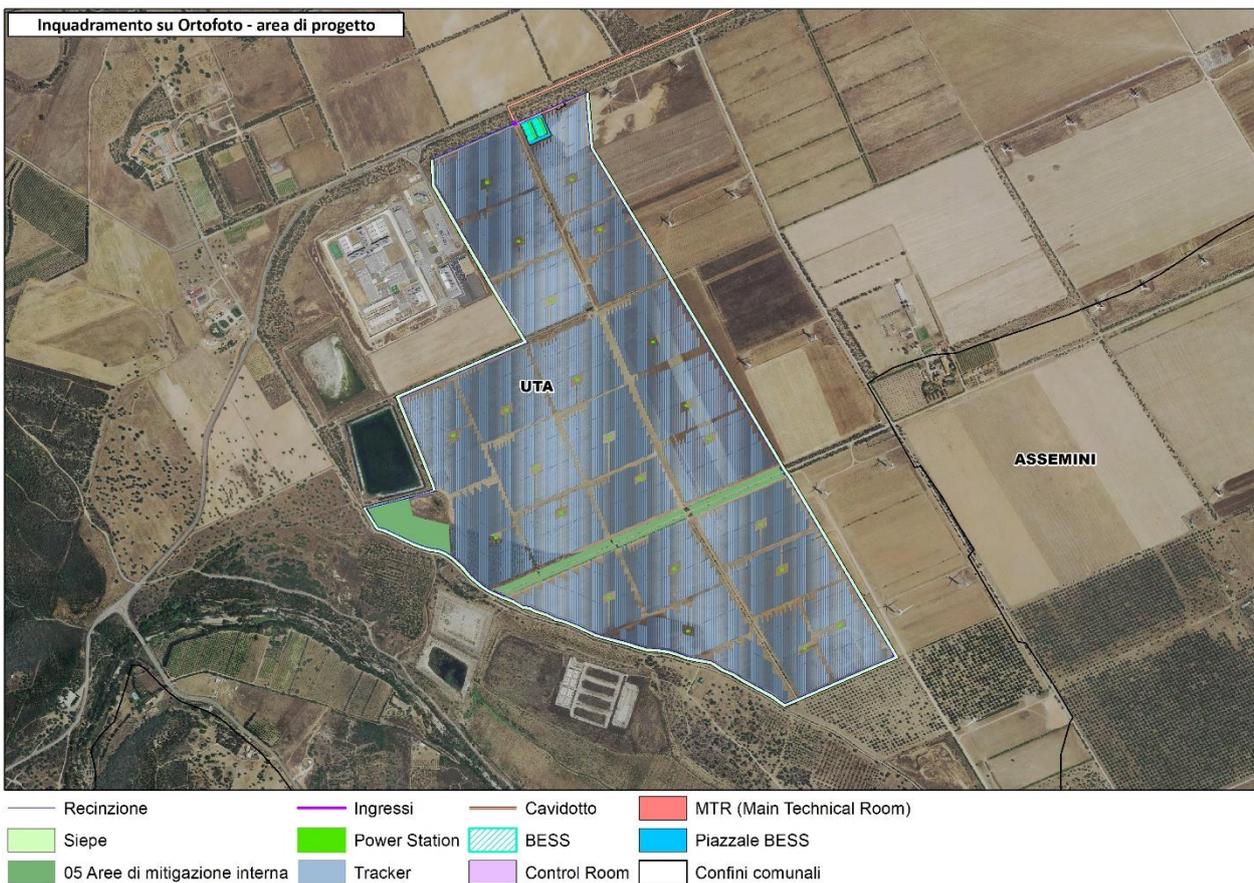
inquadramento su ortofoto - vista di dettaglio.
